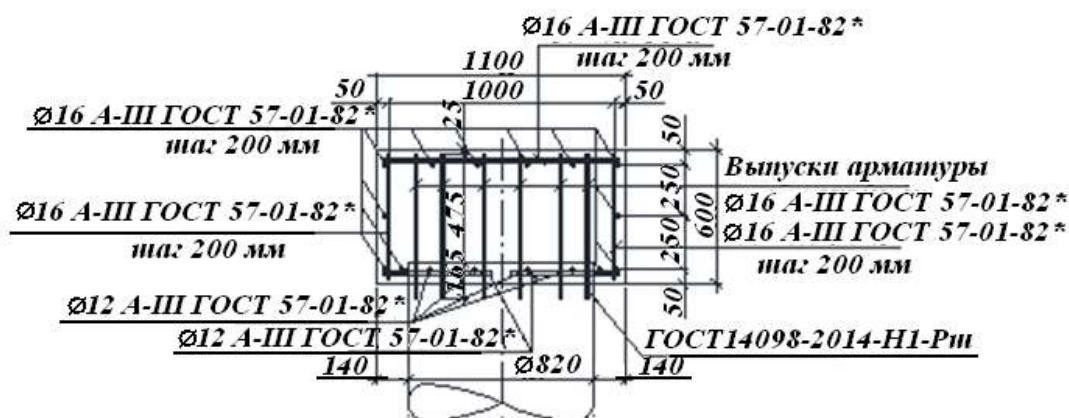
Типовое сечение железобетонного оголовка
